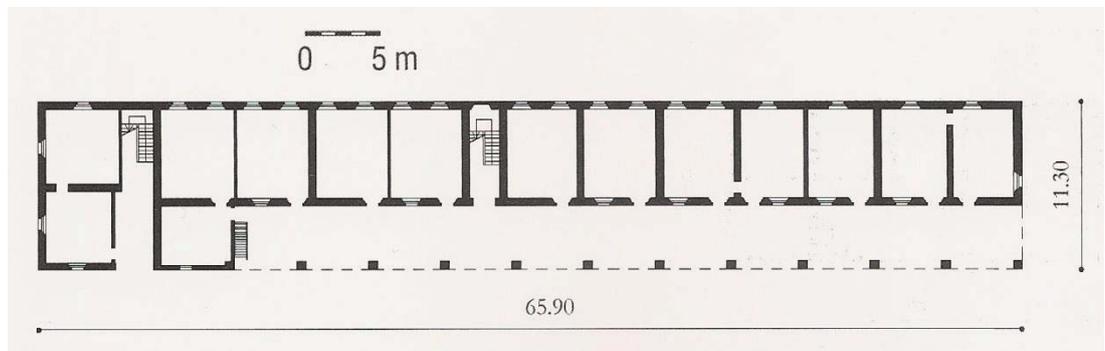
Cantù, località Cucciago, Cascina Violada. Pianta piano terra.
